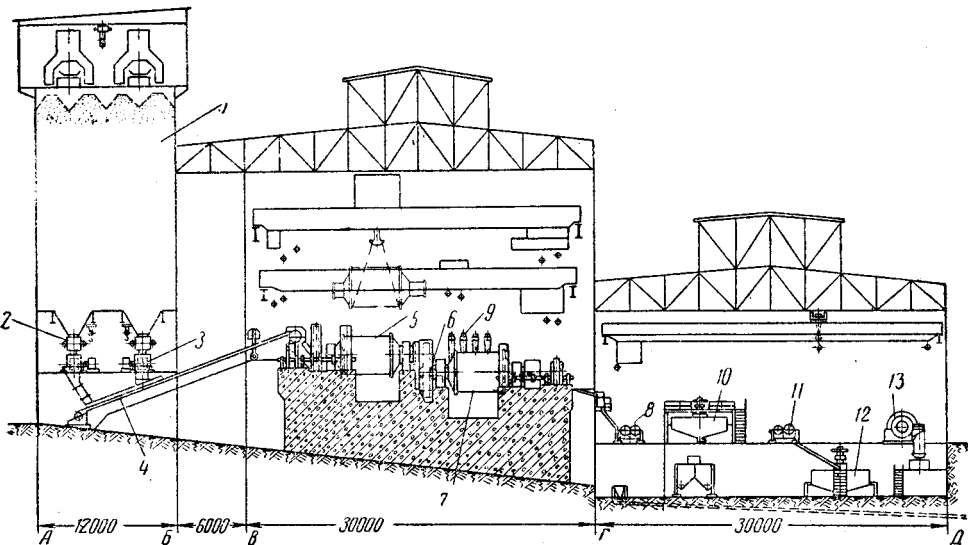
Разрез главного корпуса фабрики ЮГОК-2 (Механобр)
